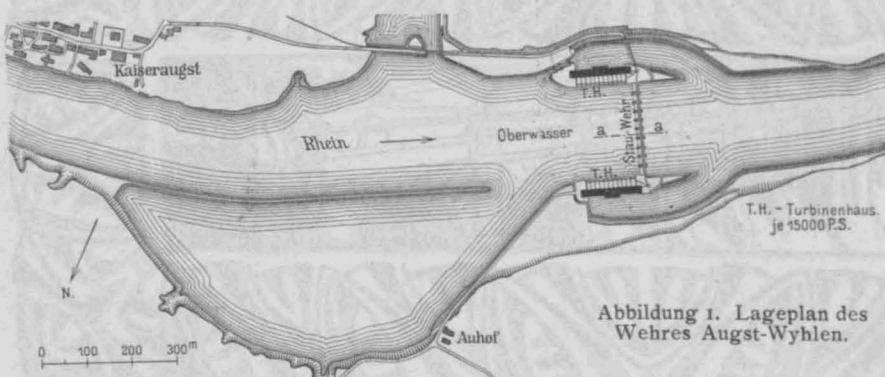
Lageplan des Wehres Augst-Wyhlen.
